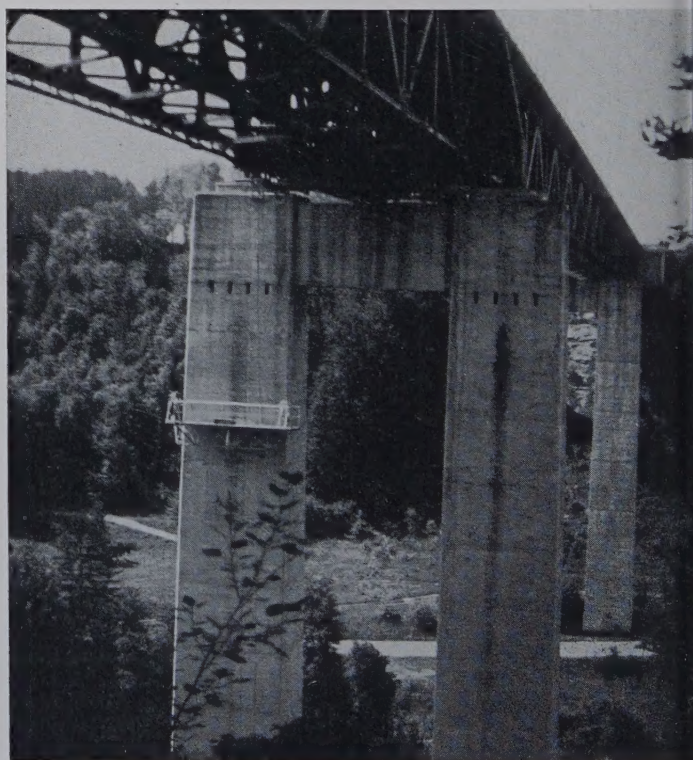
Pfeilerausbesserung mittels des gleichen Besichtigungswagens
